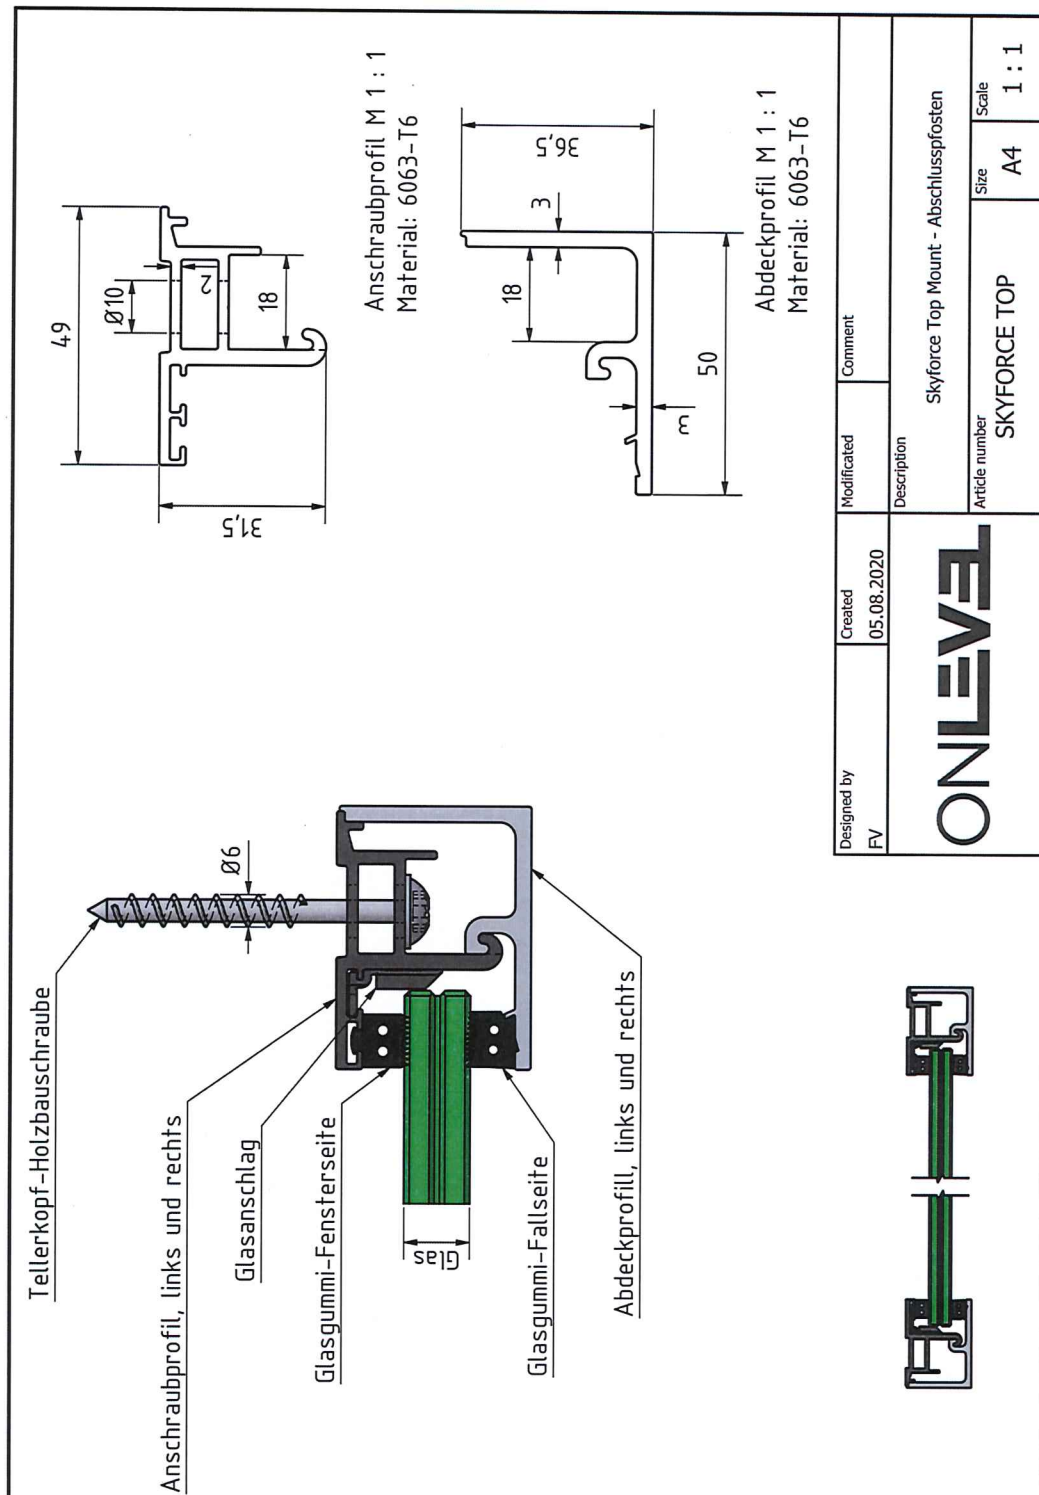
Technische Zeichnung des Auftraggebers – Skyforce Top – Randprofil mit Holzbauschraube
